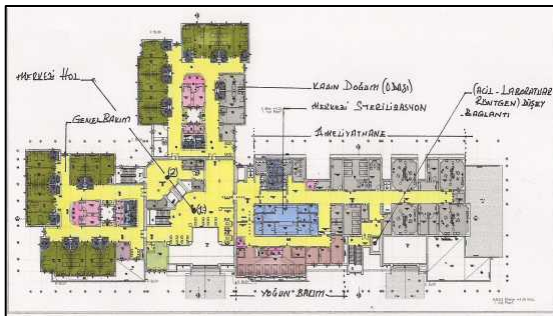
(a). Bodrum Kat Planı (-4.20 kotu)
